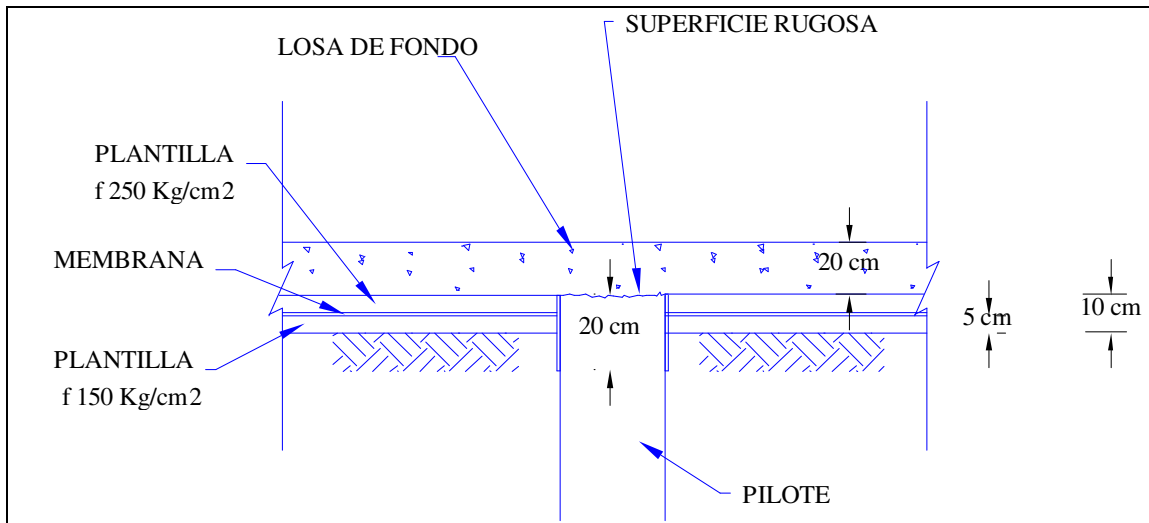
Corte de Unión de Losa de Fondo con Pilote.
